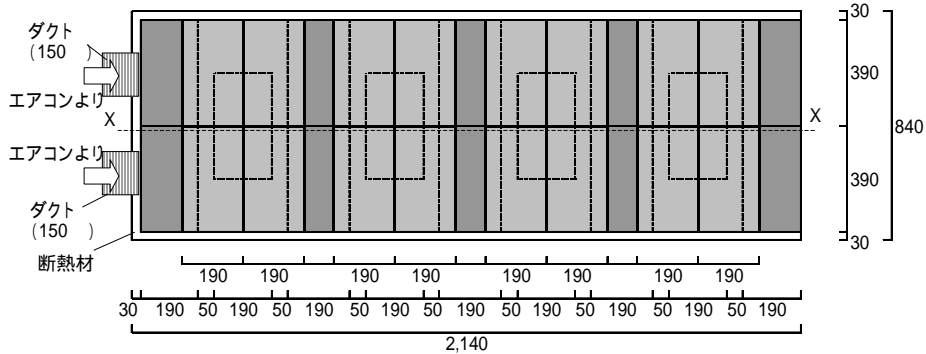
(a) 蓄熱体平面図（コンクリートブロック）
